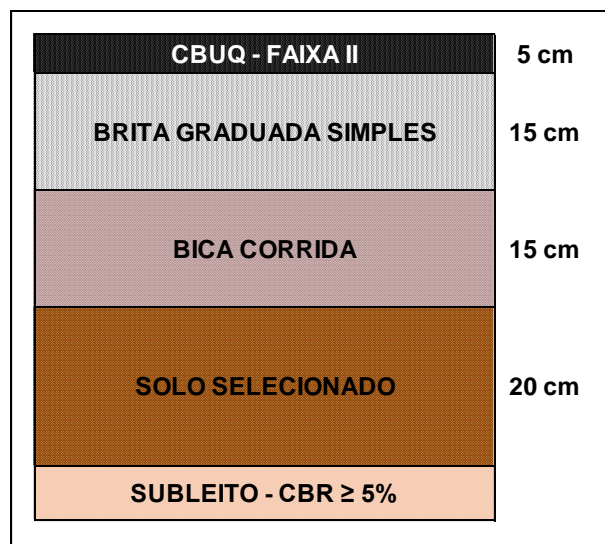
Estrutura Proposta para o Pavimento Flexível.
